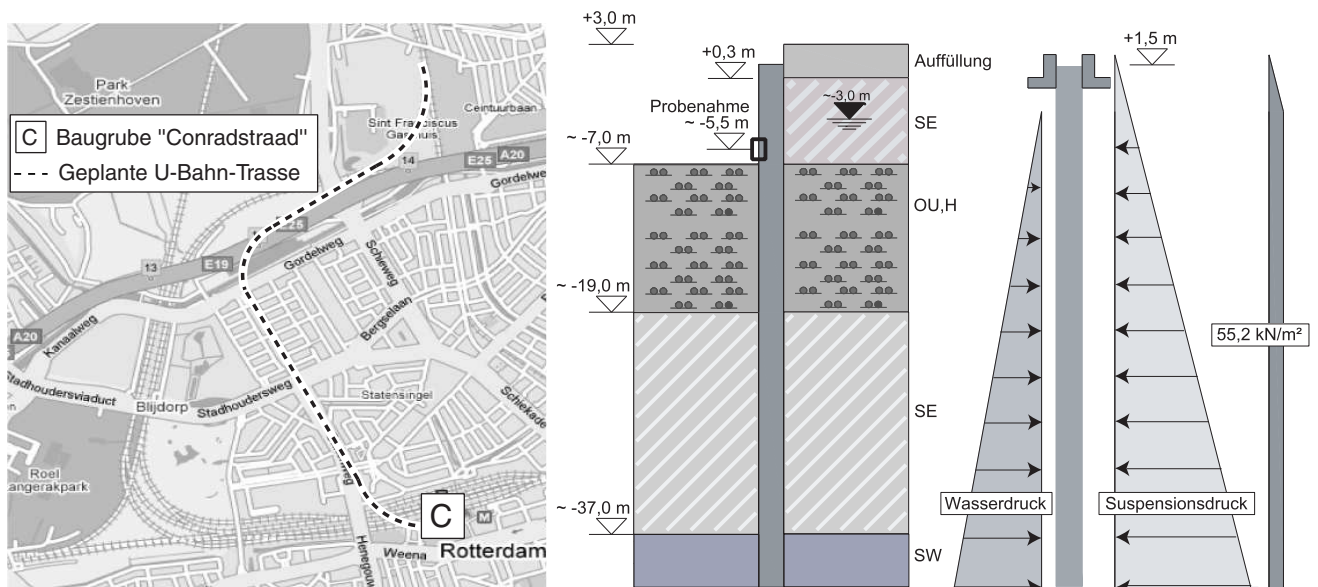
Lageplan der U-Bahn-Baugrube "Conradstraat" (Niederlande)
